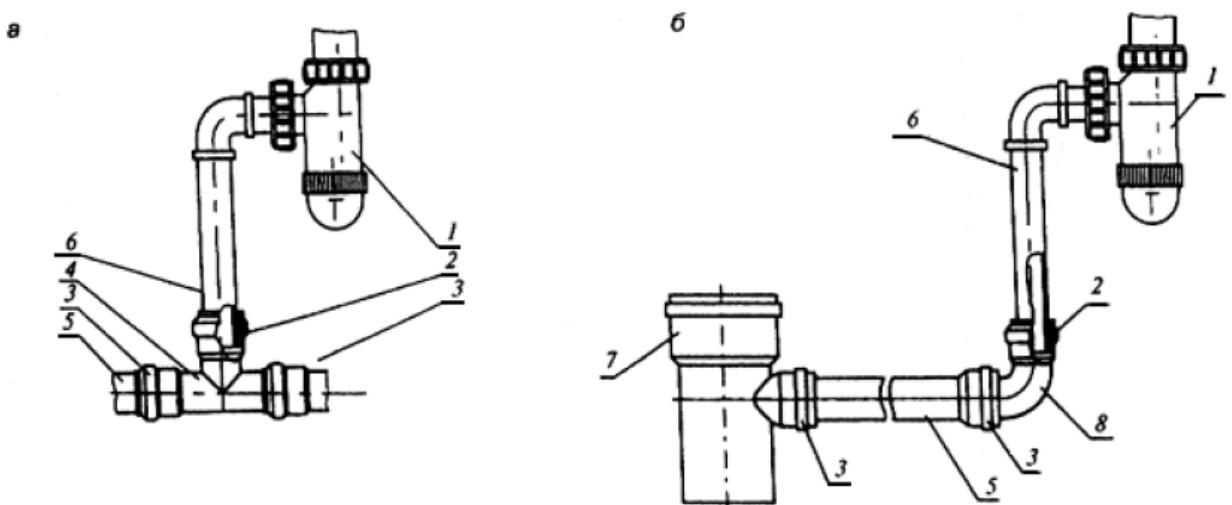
Соединение отводных труб с трубопроводами
